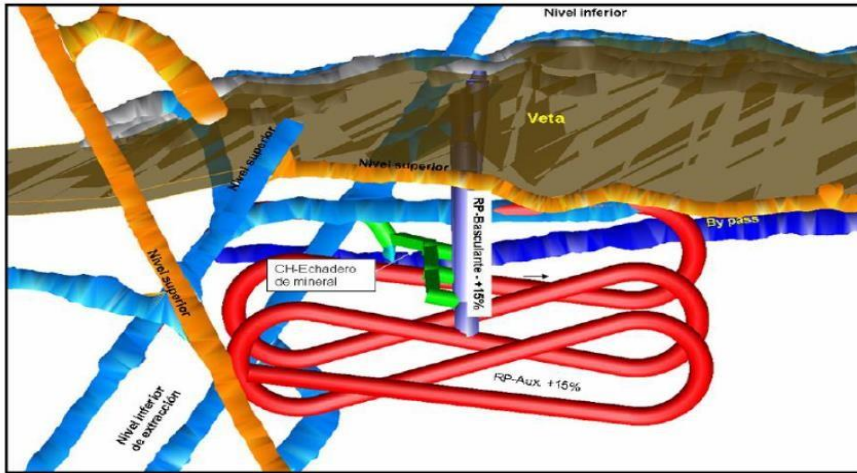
Vista en planta de la rampa basculante auxiliar. Tomada del Departamento de Geomecánica
